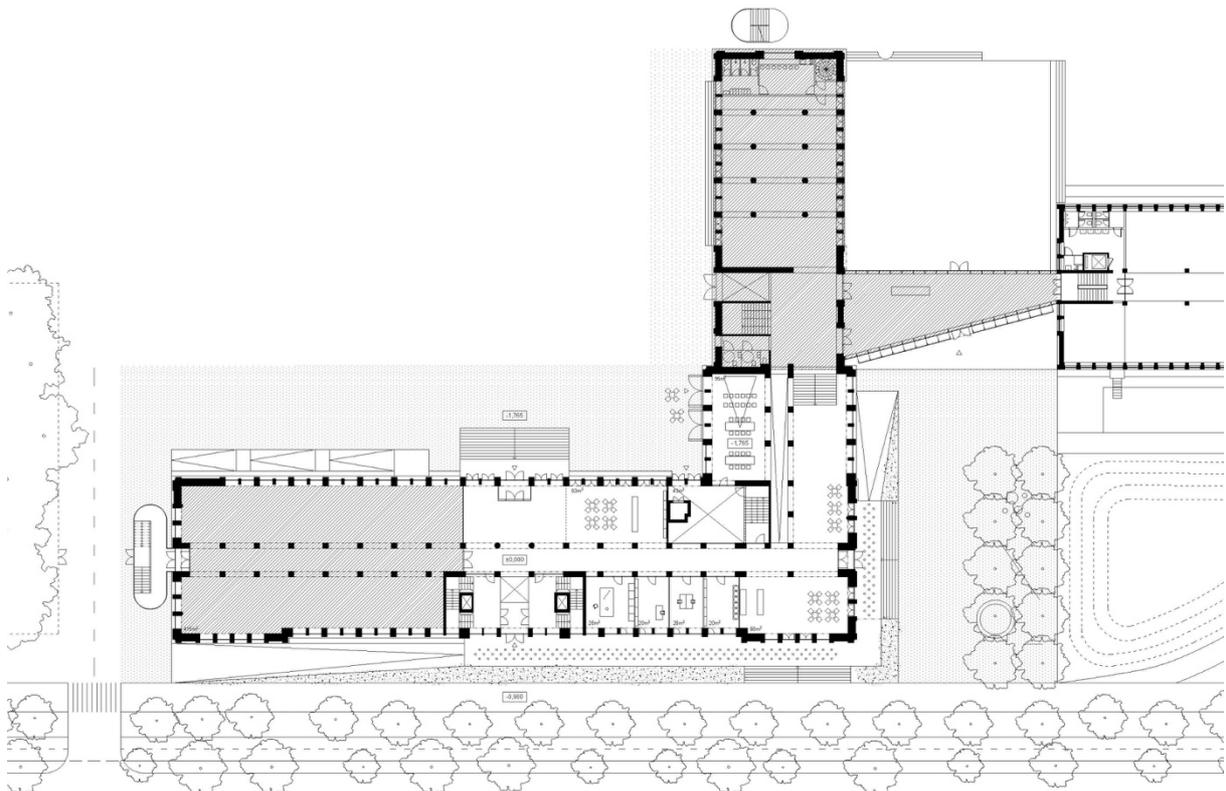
Grundriss Level 1 – Erdgeschoss mit öffentlichen Funktionen. Autoren: PLURAL
